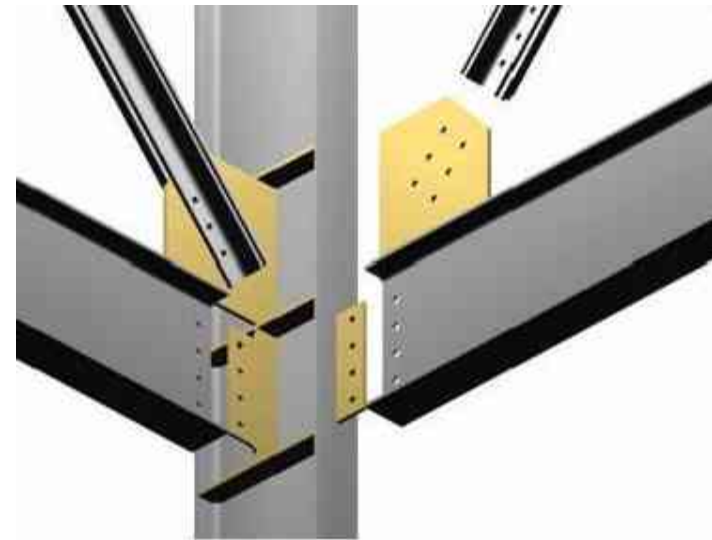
Anclajes de vigas para una estructura de acero.
